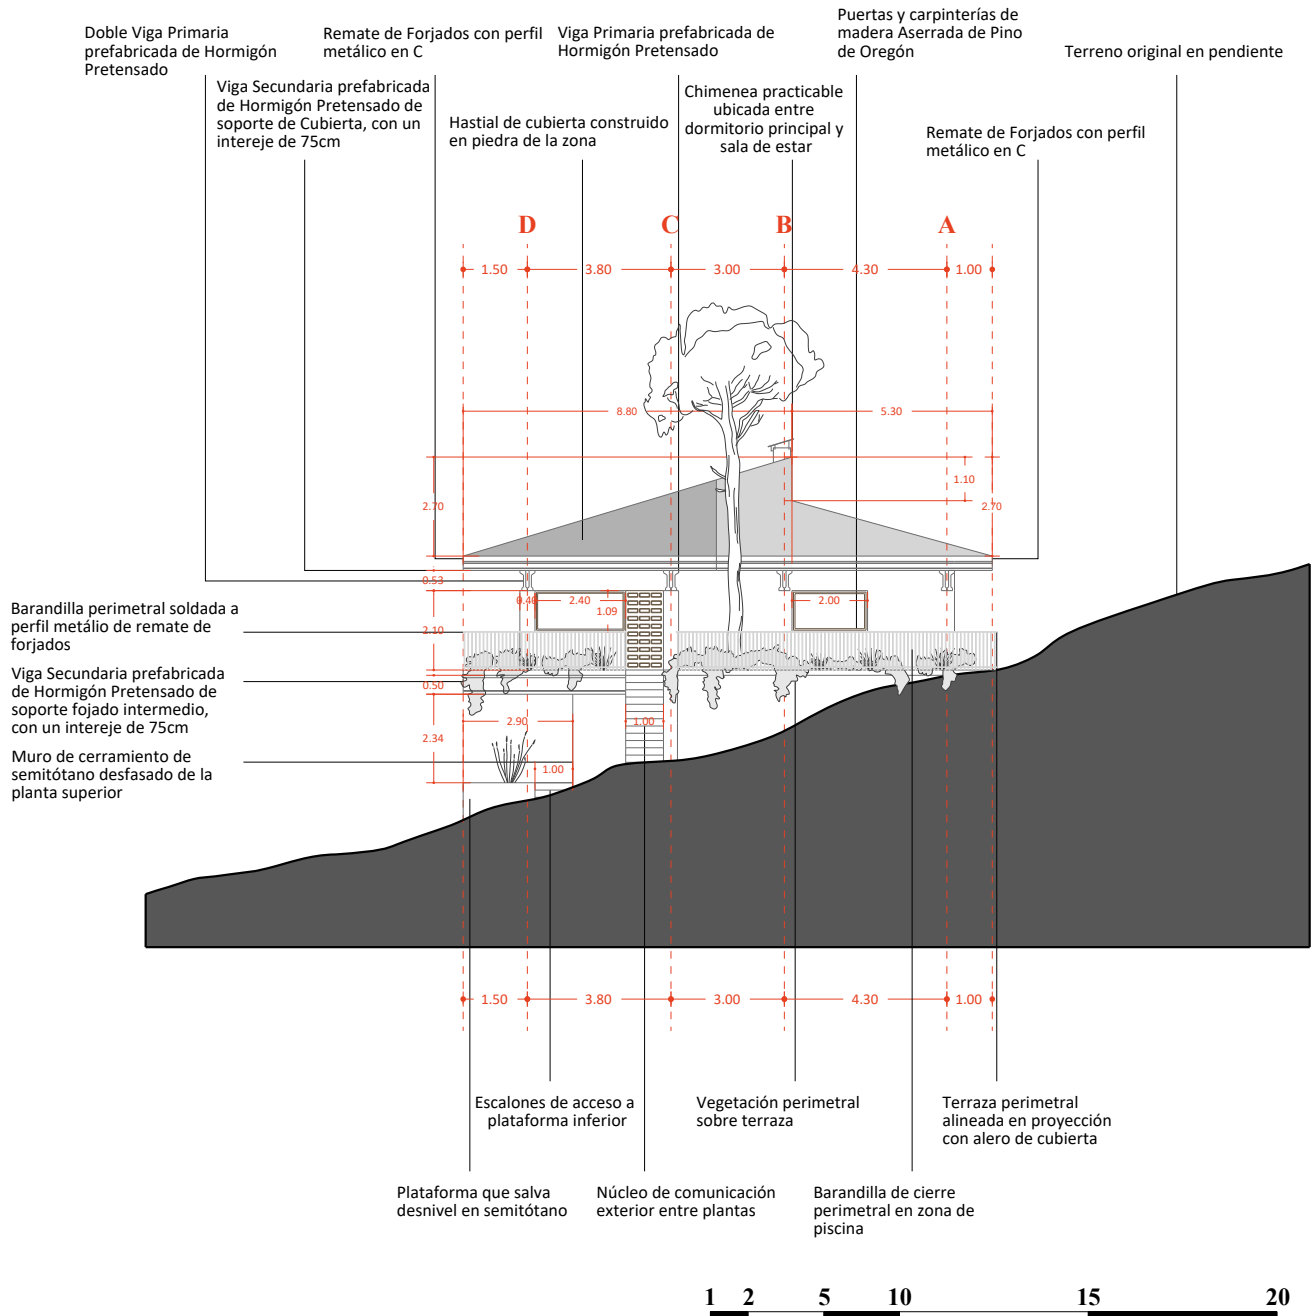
Alzado Sur de la Casa César Manrique. Elaboración Propia.
